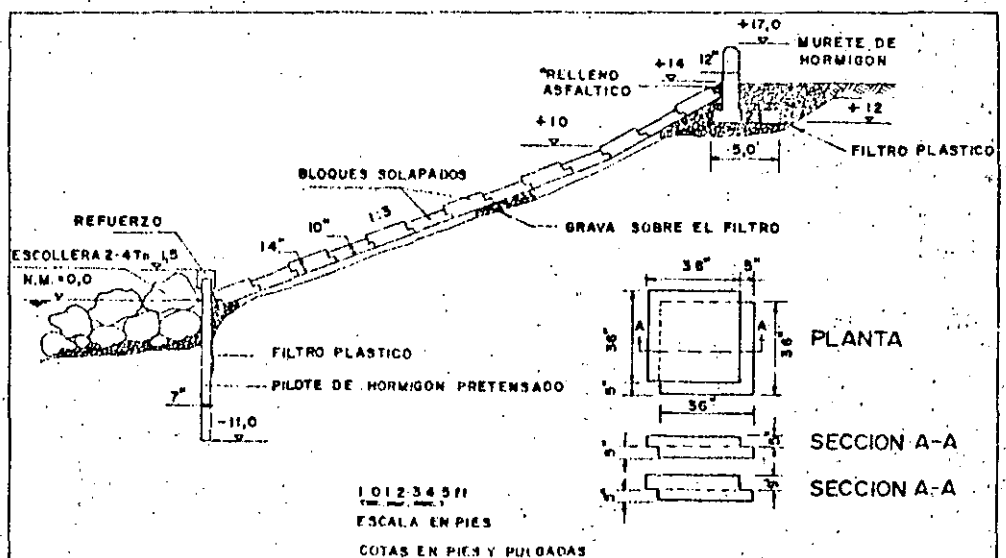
Revestimiento de las losas de hormigón solapadas
